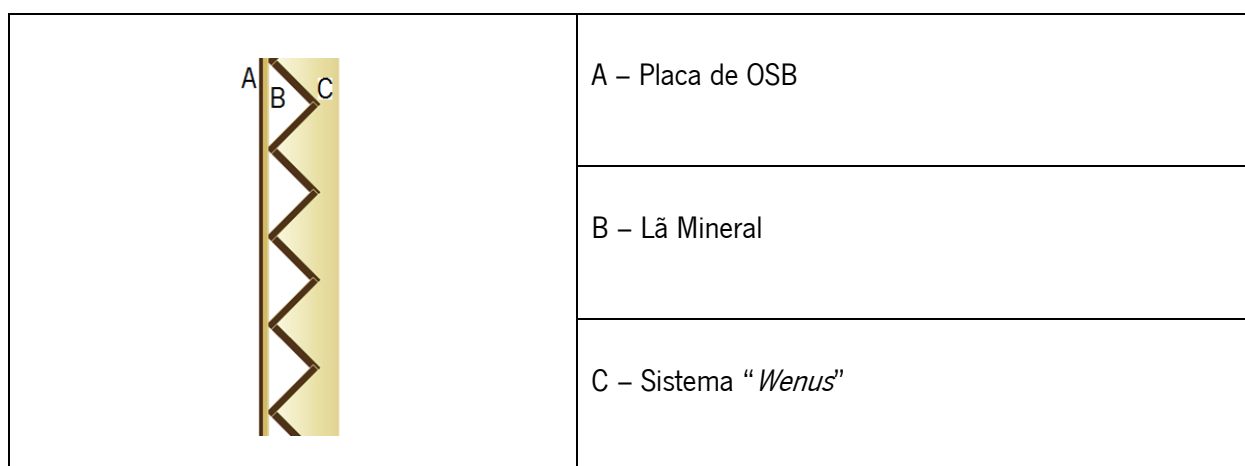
Esquema estratificado das várias camadas que compõem o sistema pré-fabricado “Wenus” como parede divisória interior (in CBS-CBT)
